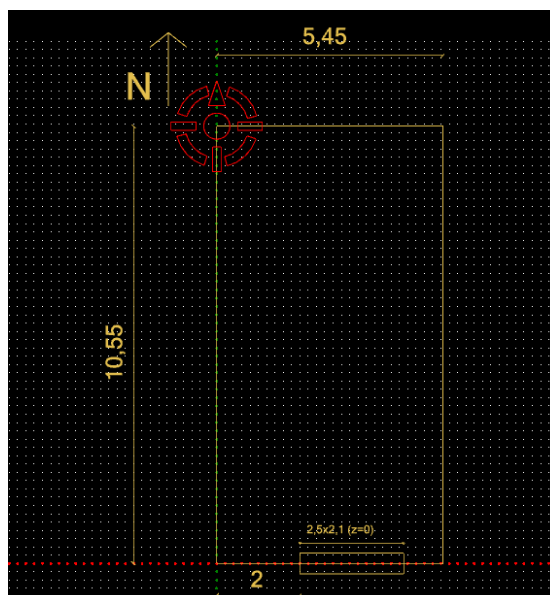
Referencia para alineación vertical de las plantillas CAD de cada planta
